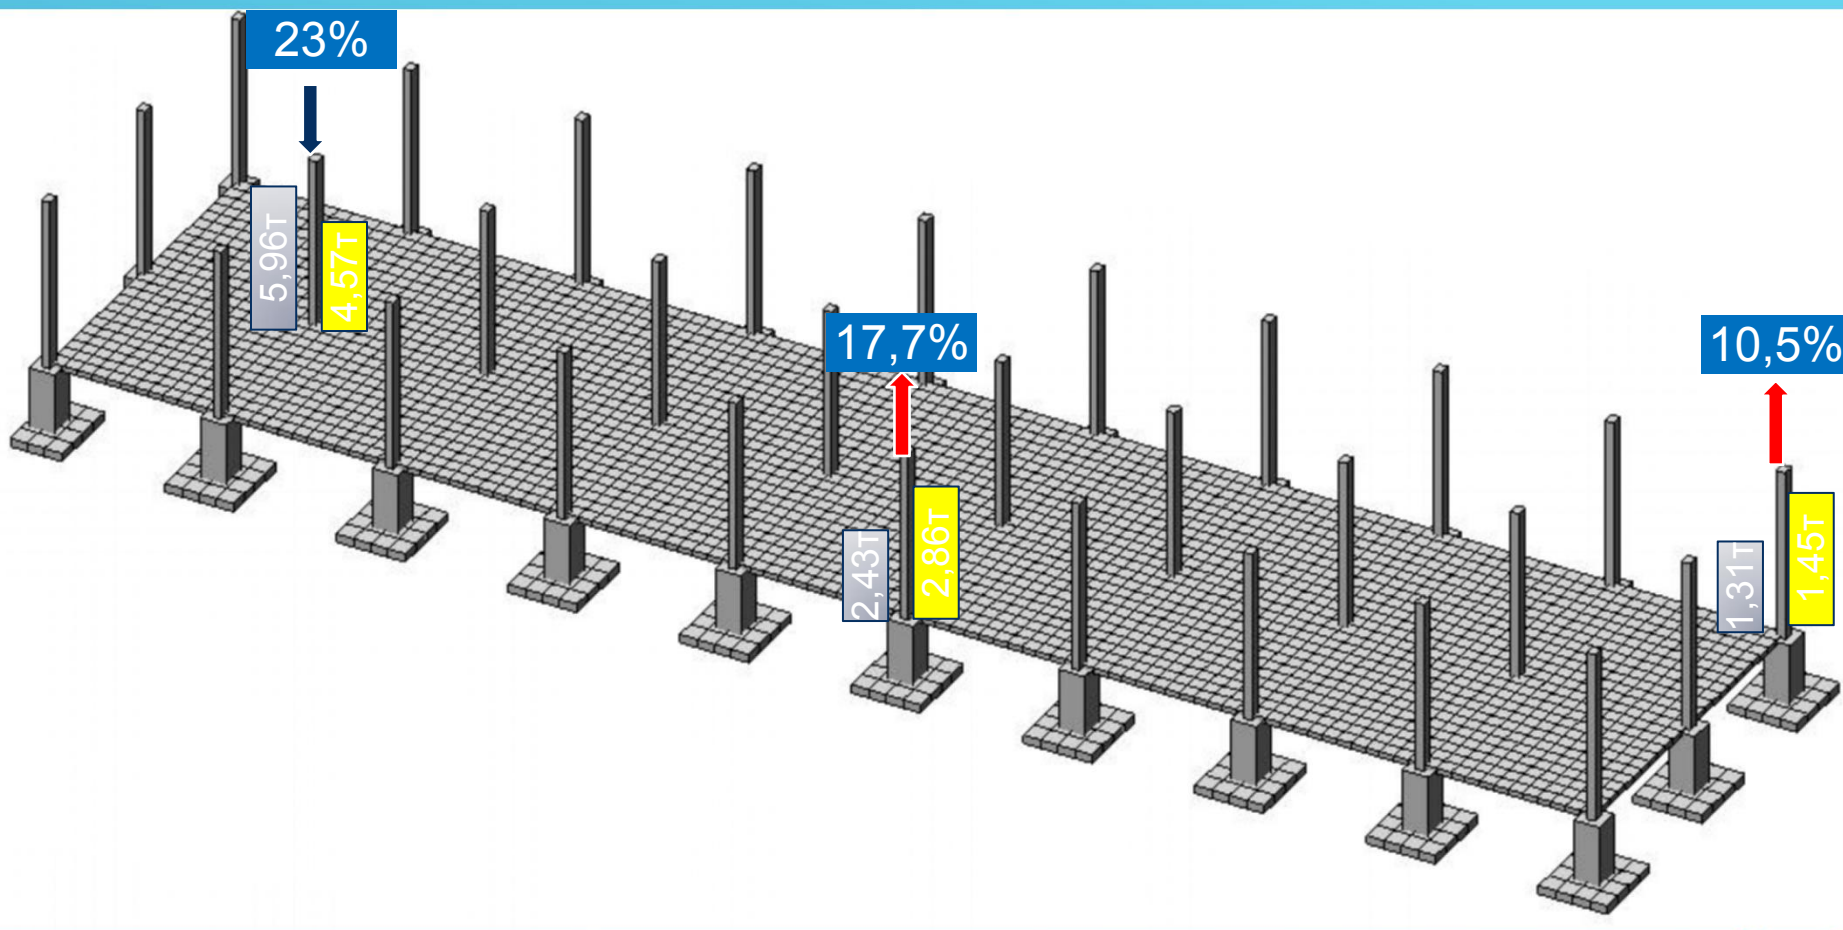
Картина перерозподілу поздовжніх сил в колонах будівлі з врахуванням реальної роботи основи
